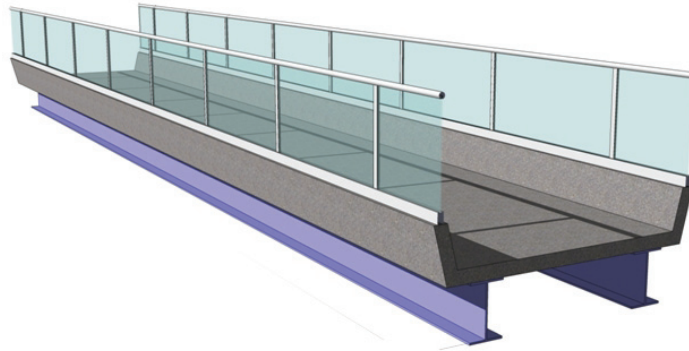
Ponte pedonal com tabuleiro misto em vigas de GFRP e laje de SFRSCC.
